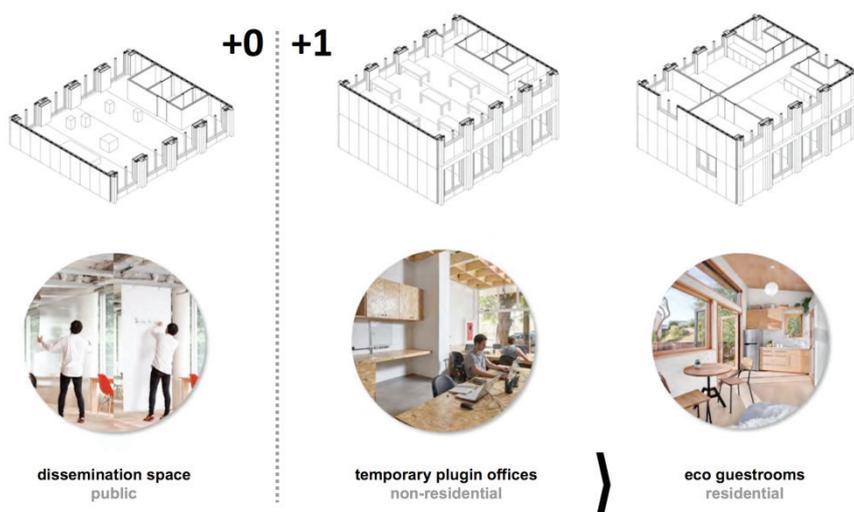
Trasformabilità dell'edificio prevista dal progetto (credit VUB Architectural Engineering)
